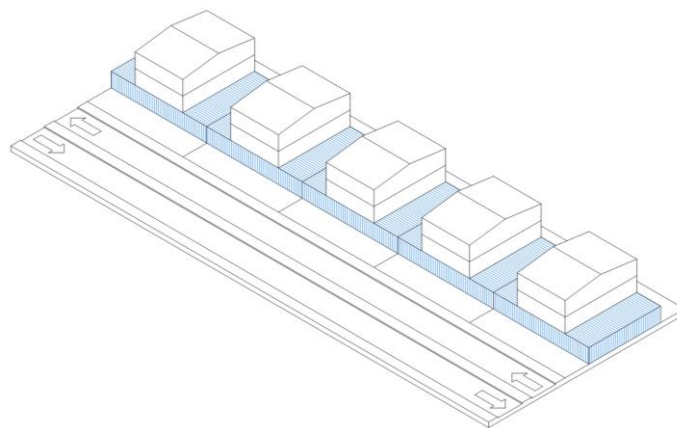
Comercio en planta baja adosado hacia los costados. Elaboración grupal Taller Avanzado
